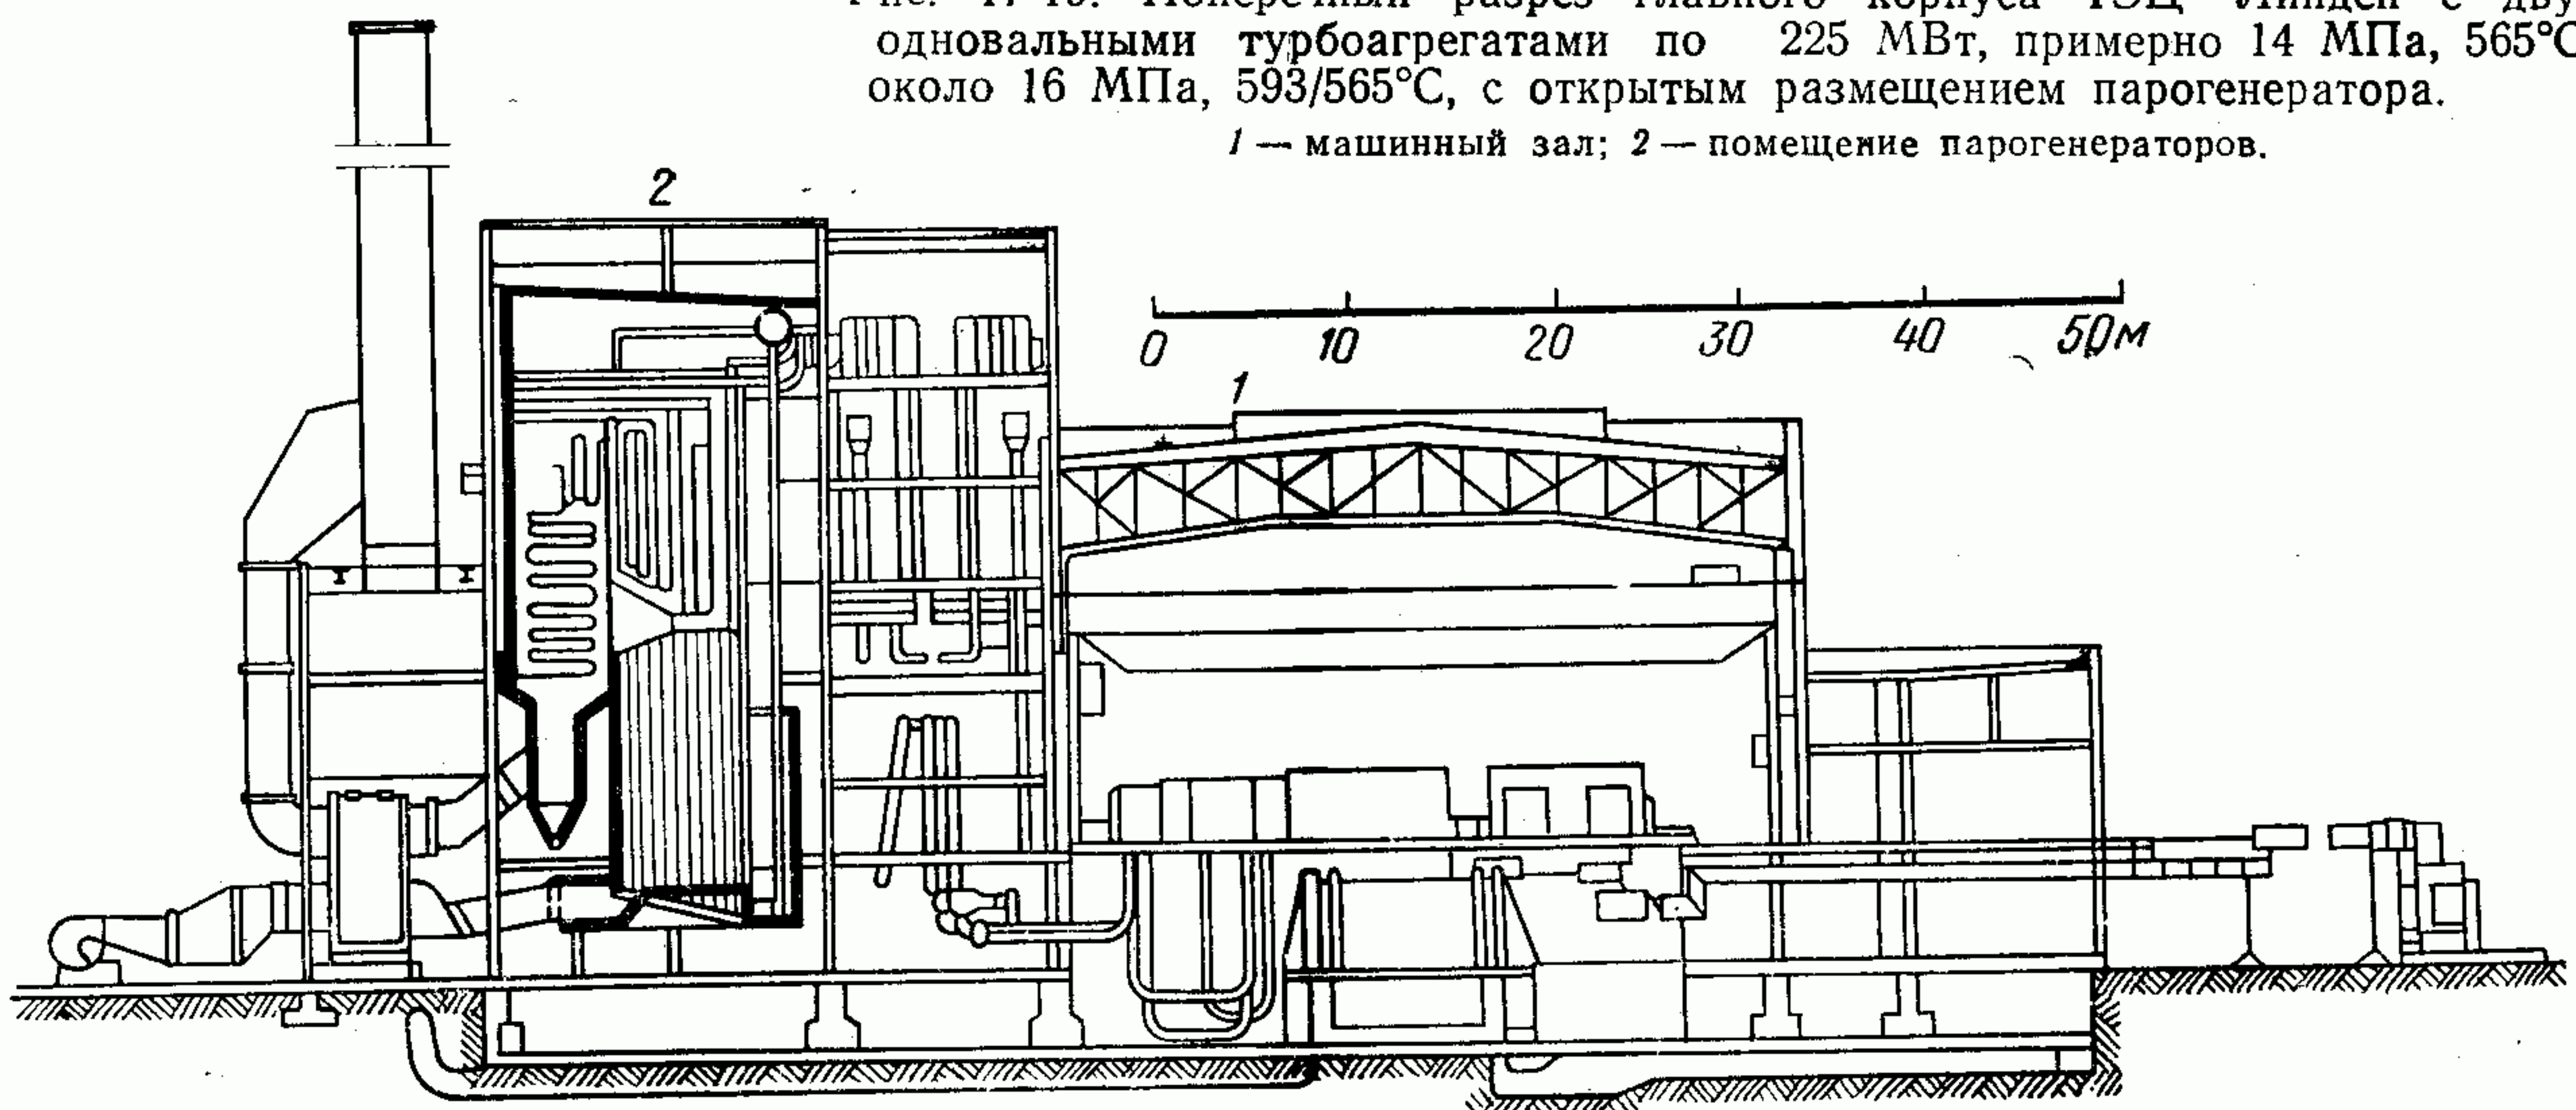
Поперечный разрез главного корпуса ТЭЦ Линден с двумя
